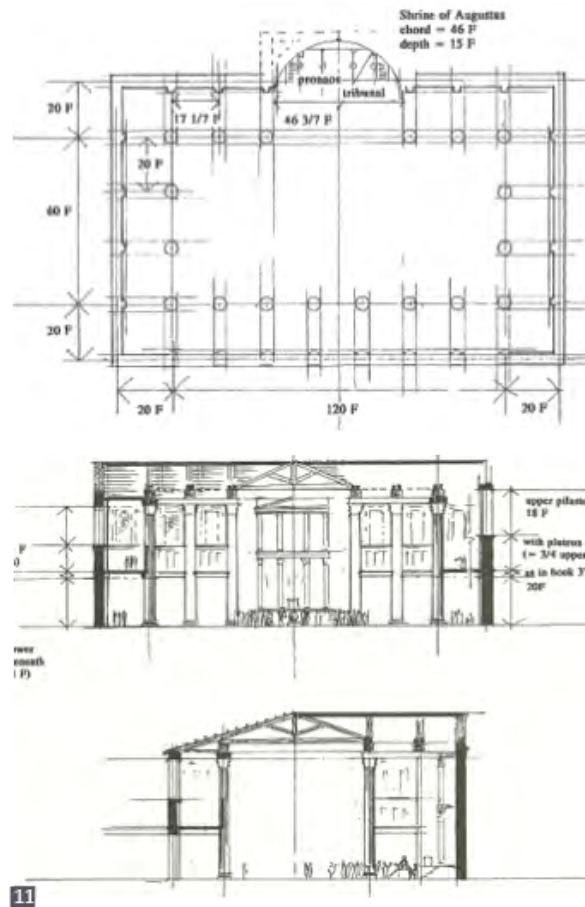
planta baixa e corte da basílica de Fano em Rowland
